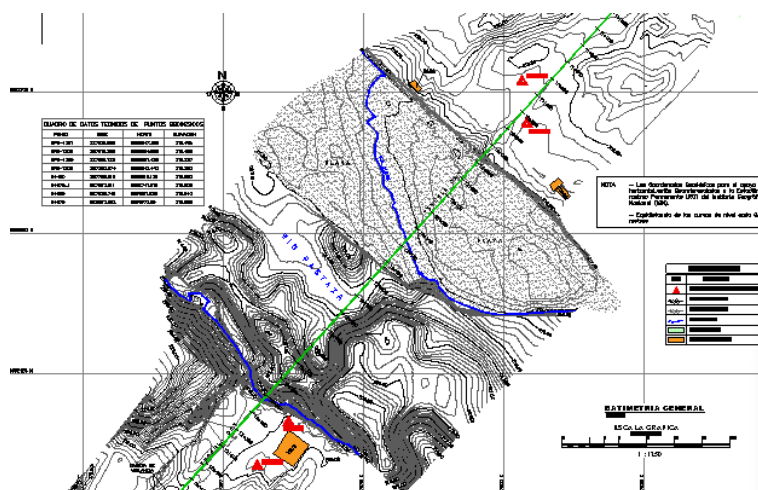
Plano de planta del sector en estudio generado en AutoCAD, levantamiento batimétrico entre km 11 y km 12 ORN
